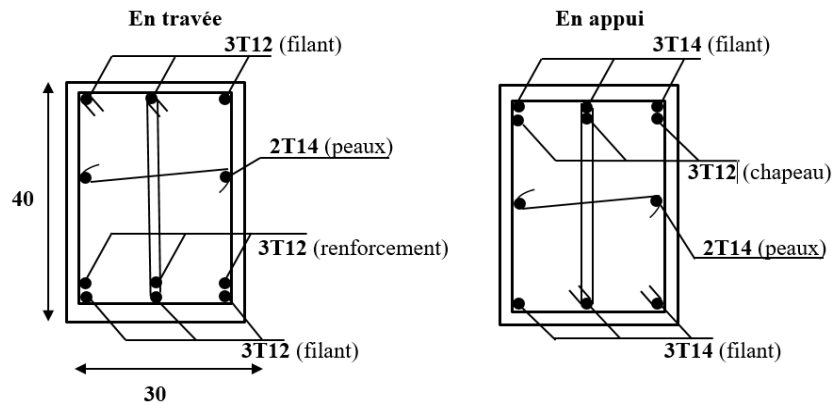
Schéma de ferraillage les poutres secondaires.
